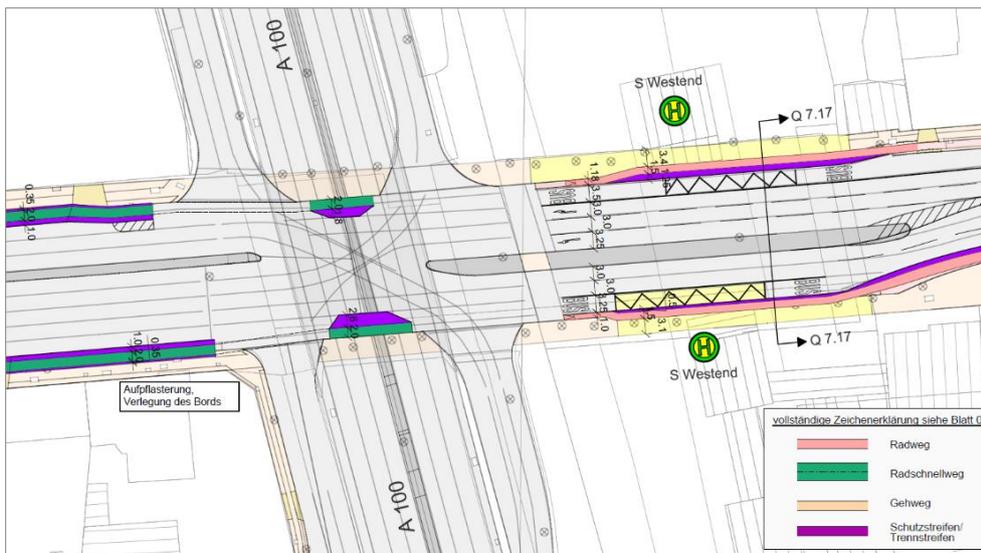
Spandauer Damm – Anschlussstelle A 100/S-Bhf. Westend
